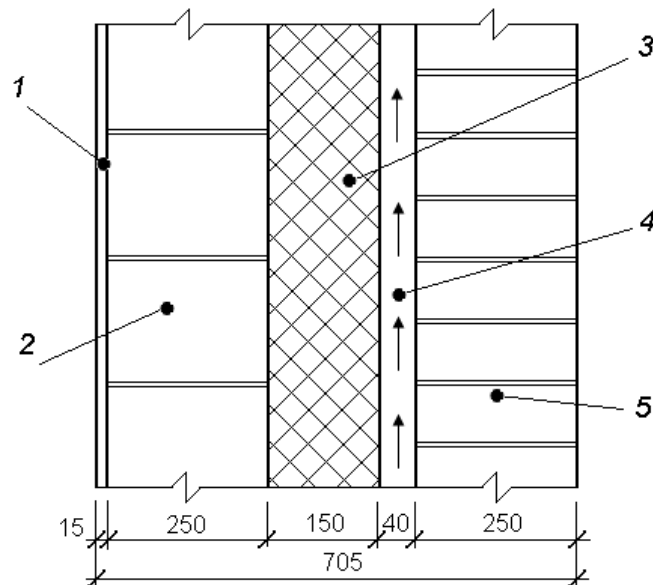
Расчетная схема наружной стены с хорошо-вентилируемой воздушной прослойкой: 1 — внутренняя штукатурка; 2 — внутренний слой кирпичной кладки; 3 — теплоизоляция; 4 — воздушная прослойка, вентилируемая наружным воздухом; 5 — лицевой кирпичный слой
